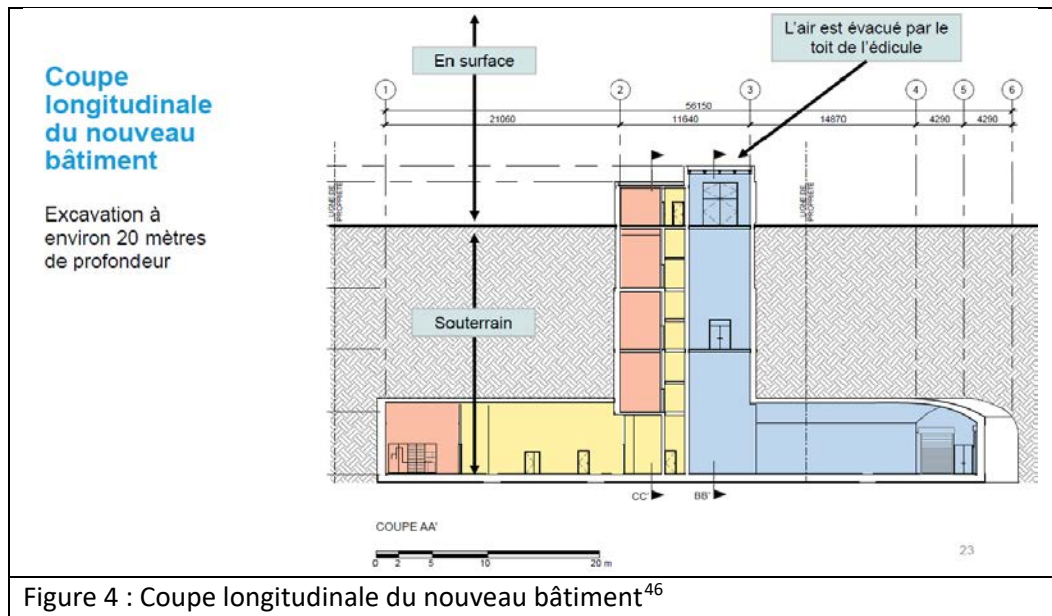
Coupe longitudinale du nouveau bâtiment⁴⁶
